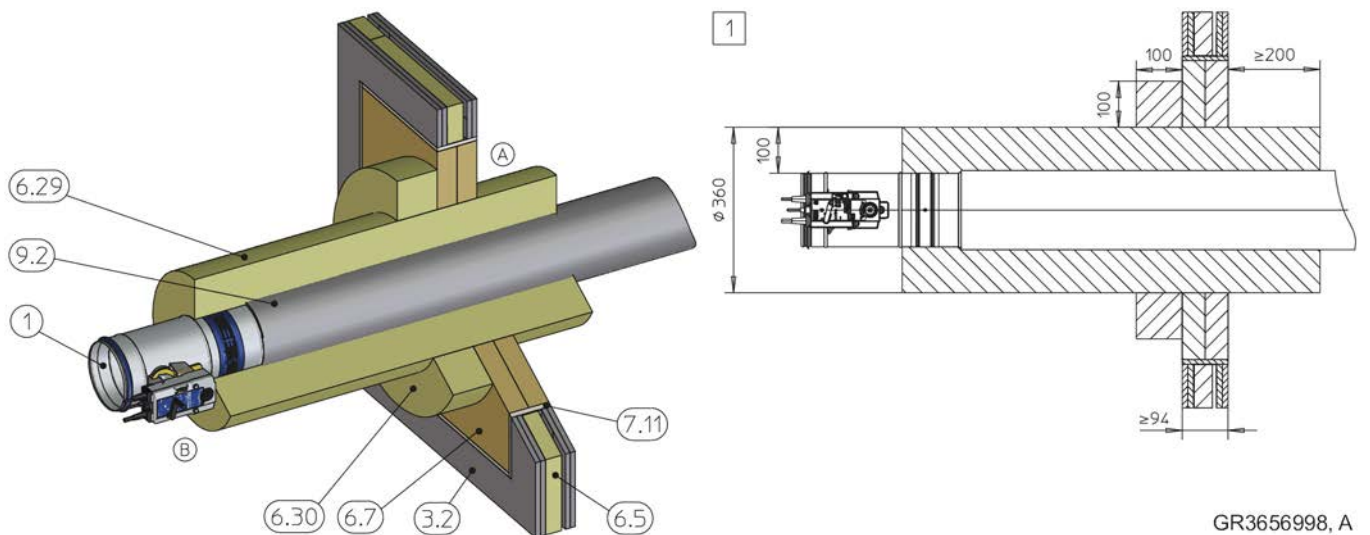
Монтаж на удалении от легких перегородок без применения строительного монтажа, с монтажной плитой
